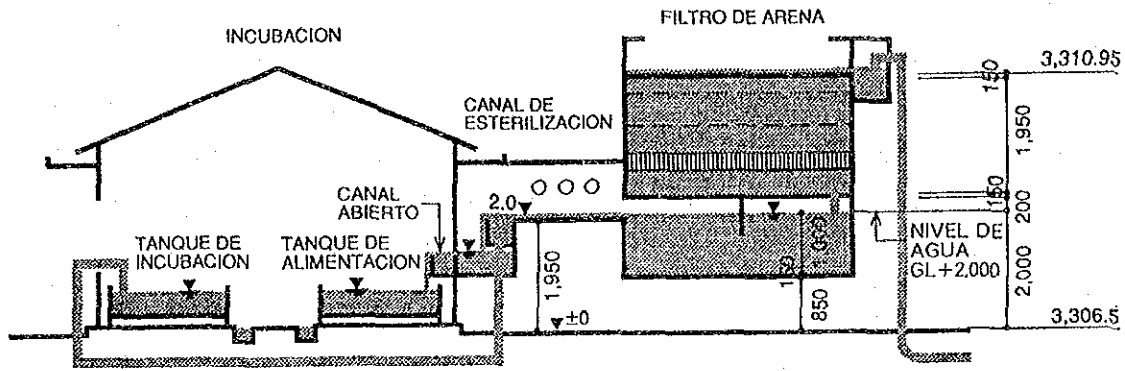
Plan seccional del filtro de arena y la nave de incubación
